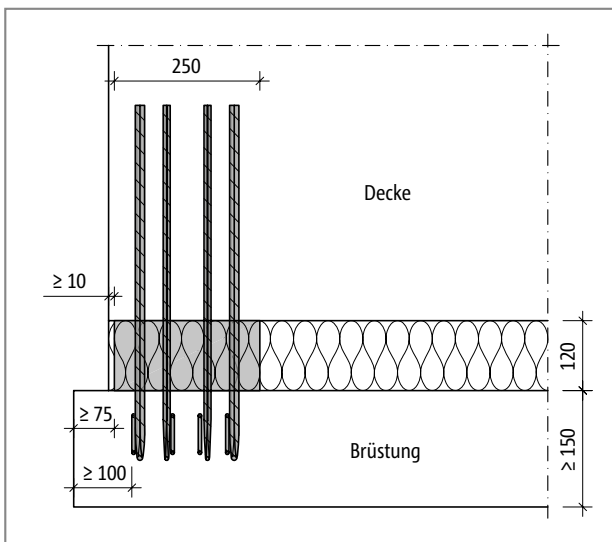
Schöck Isokorb® XT Typ F: Aufsicht Randabstände
